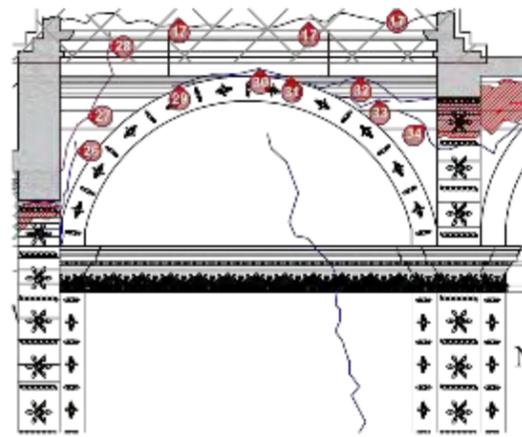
Detalle de afectaciones en juego de molduras de muro interior sur en Nave tramo 2
